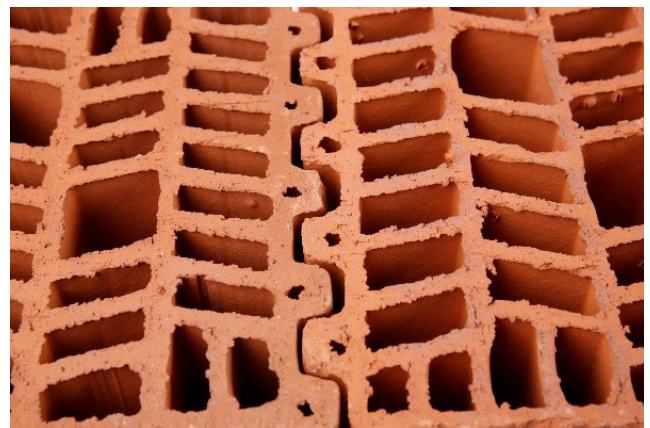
Pormenor do encaixe entre tijolos “térmicos” (produtos da fábrica Preceram).
